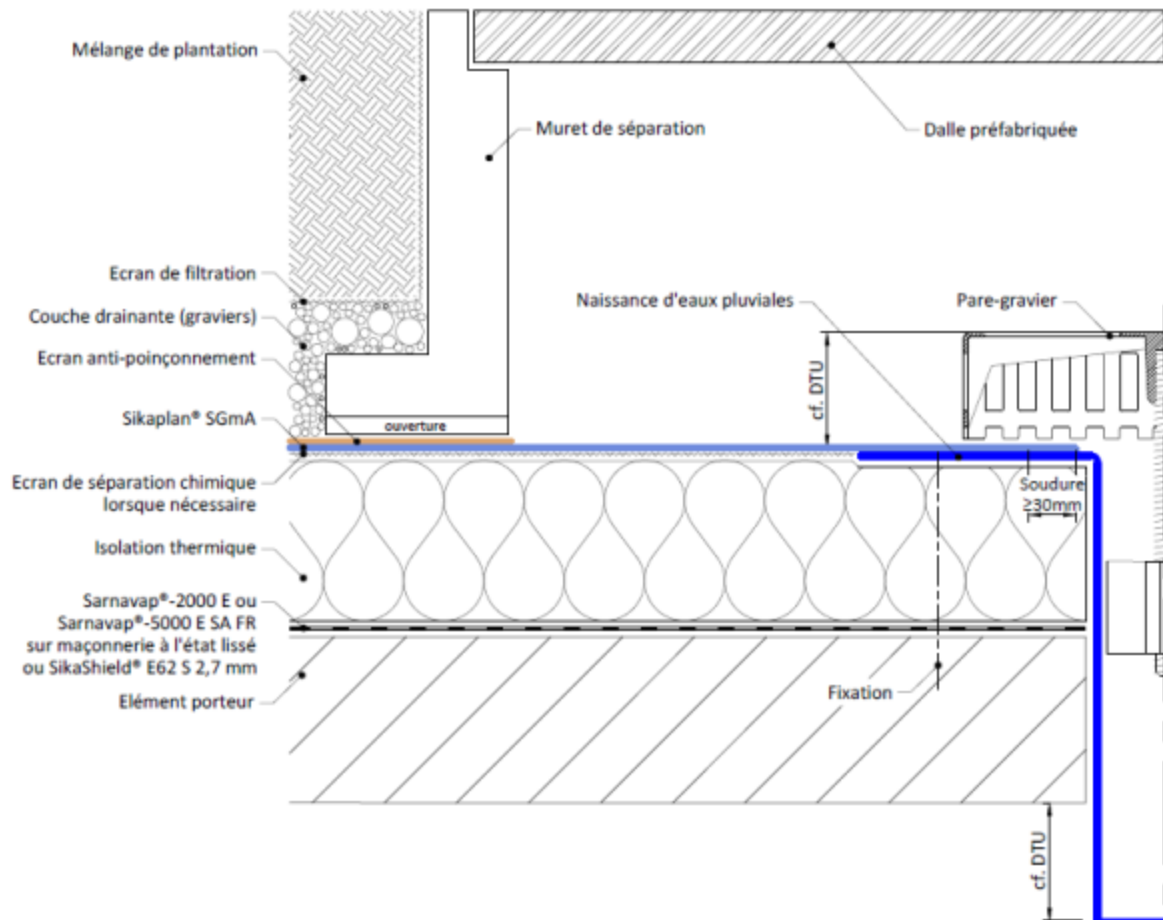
Relevé d'étanchéité sur acrotère avec zone stérile – Travaux neufs sur maçonnerie avec parement « à l'état lissé » au sens du NF DTU 21
